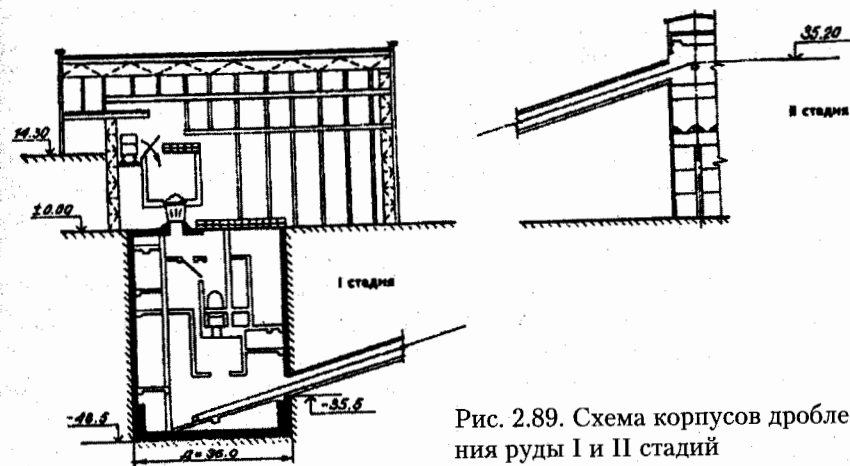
Схема корпусов дробления руды I и II стадий
